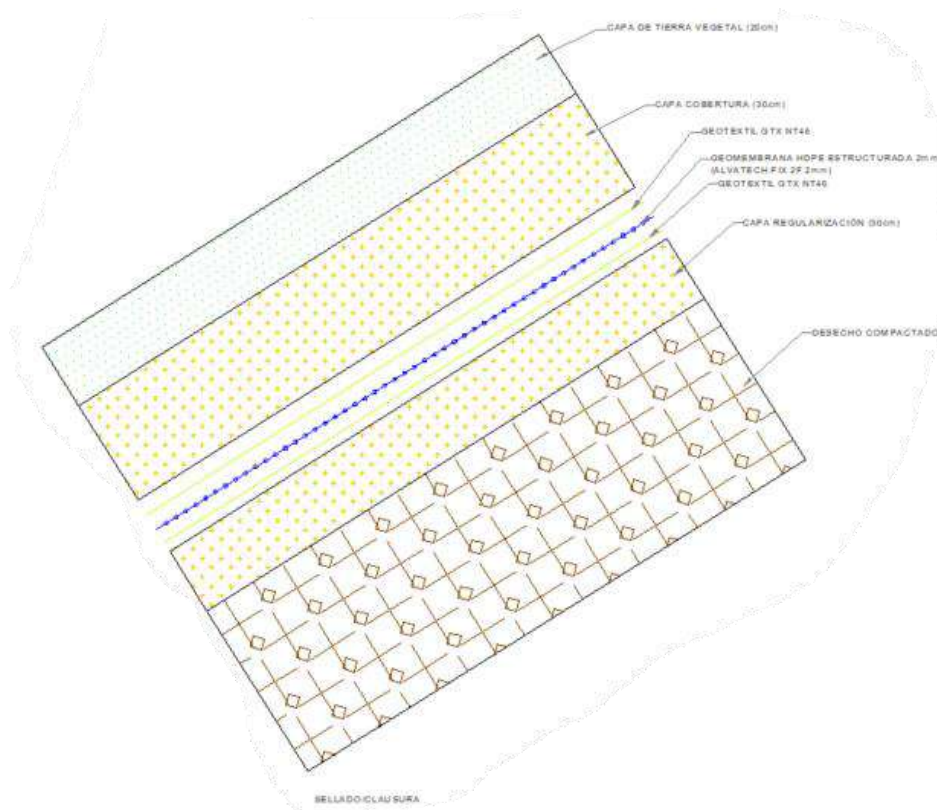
Detalle del sistema de impermeabilización sellado/clausura
